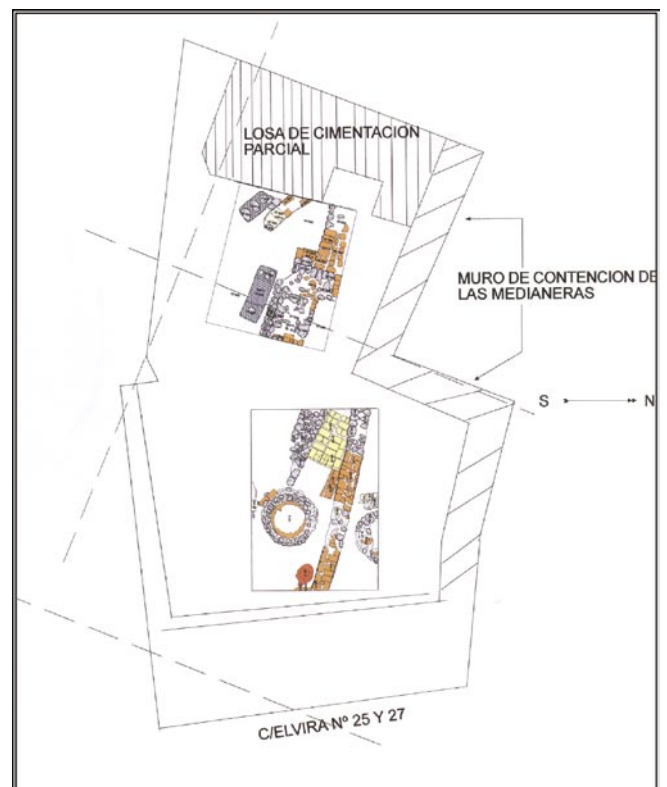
Planimetría general. Ubicación de estructuras. E. 1:100.
